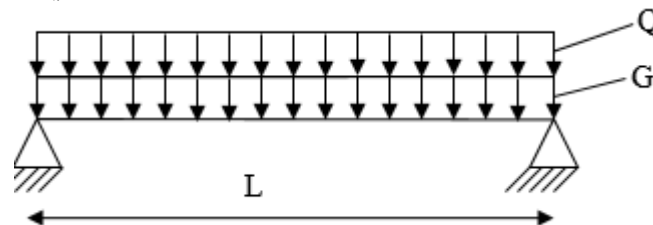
Schéma statique d'une poutrelle isostatique.
